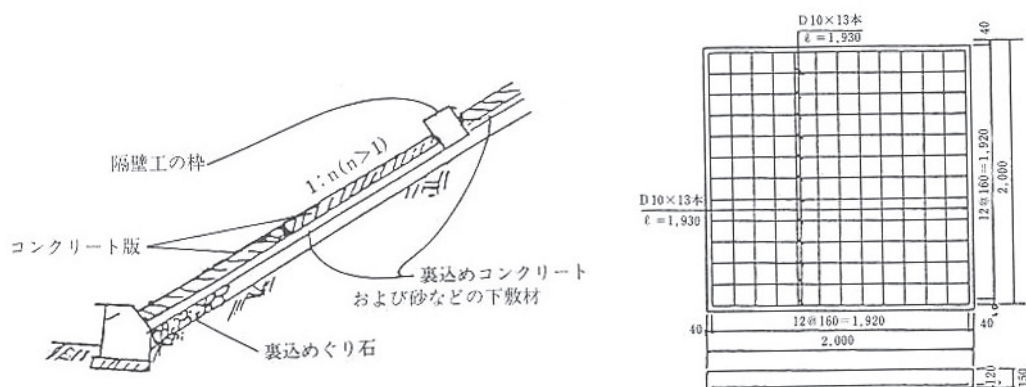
コンクリート版張工の施工断面例とコンクリート版の一例
